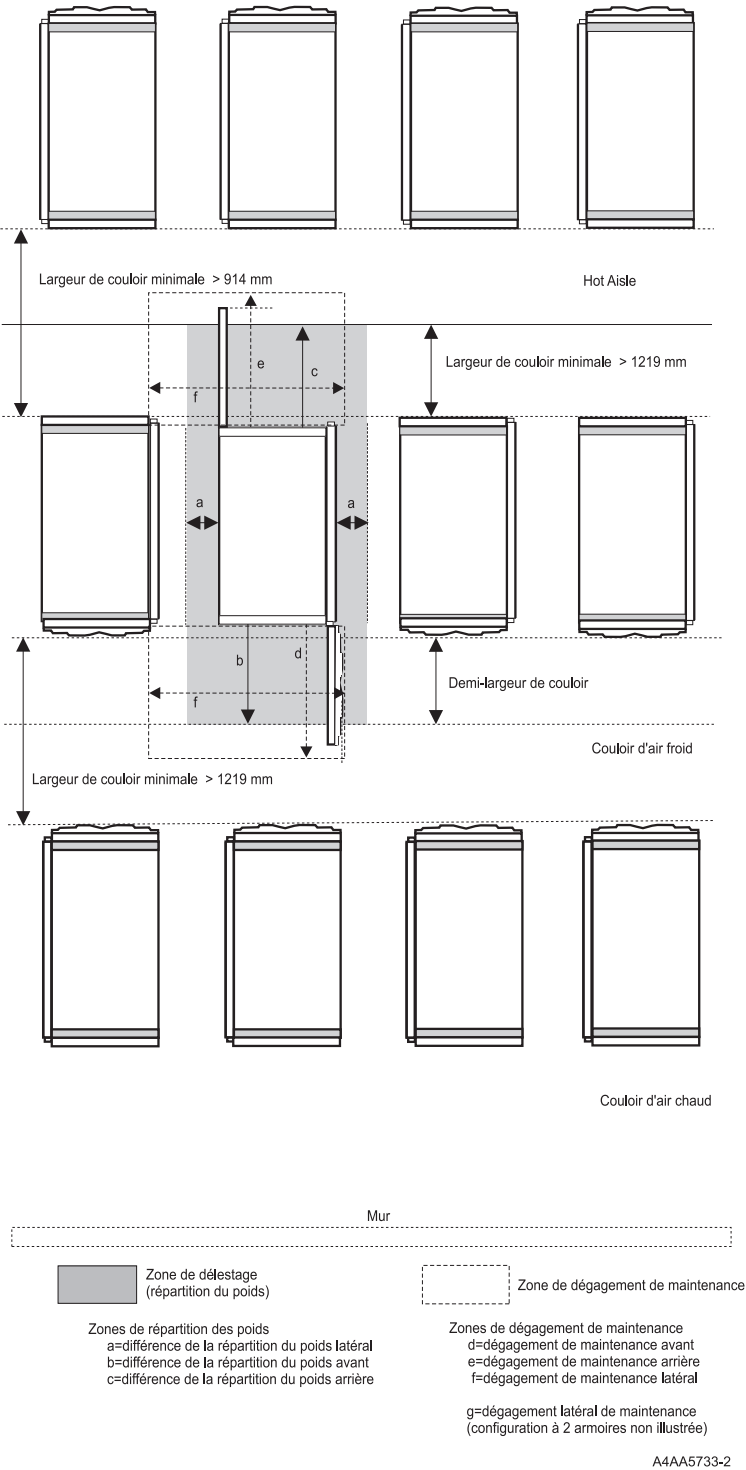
Disposition des dalles suggérée pour l'installation de plusieurs systèmes
